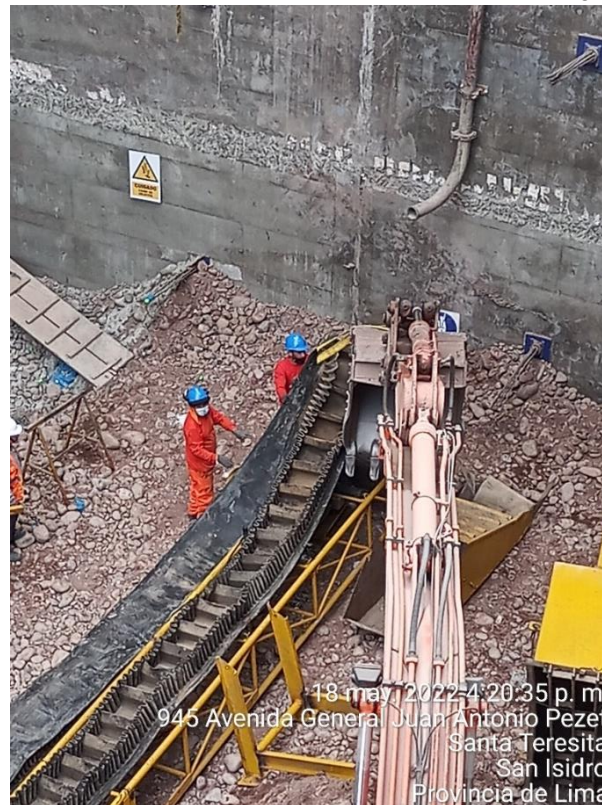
Colocación de lona o faja con ayuda de la excavadora
